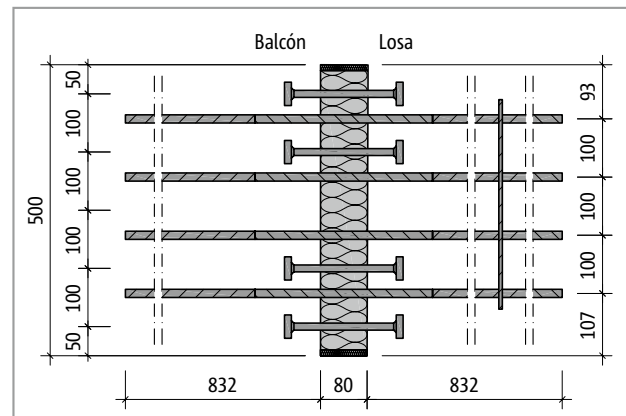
Schöck Isokorb® T tipo Q-P-V10: Plano del producto
